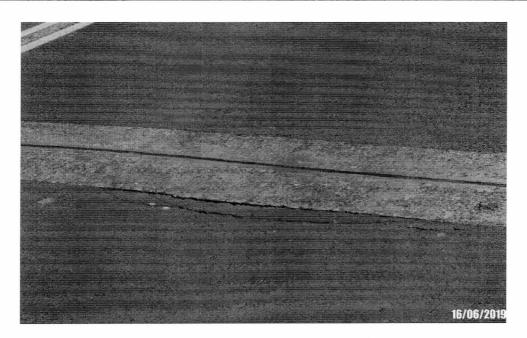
Face superior do tabuleiro apresentando fissuras.
